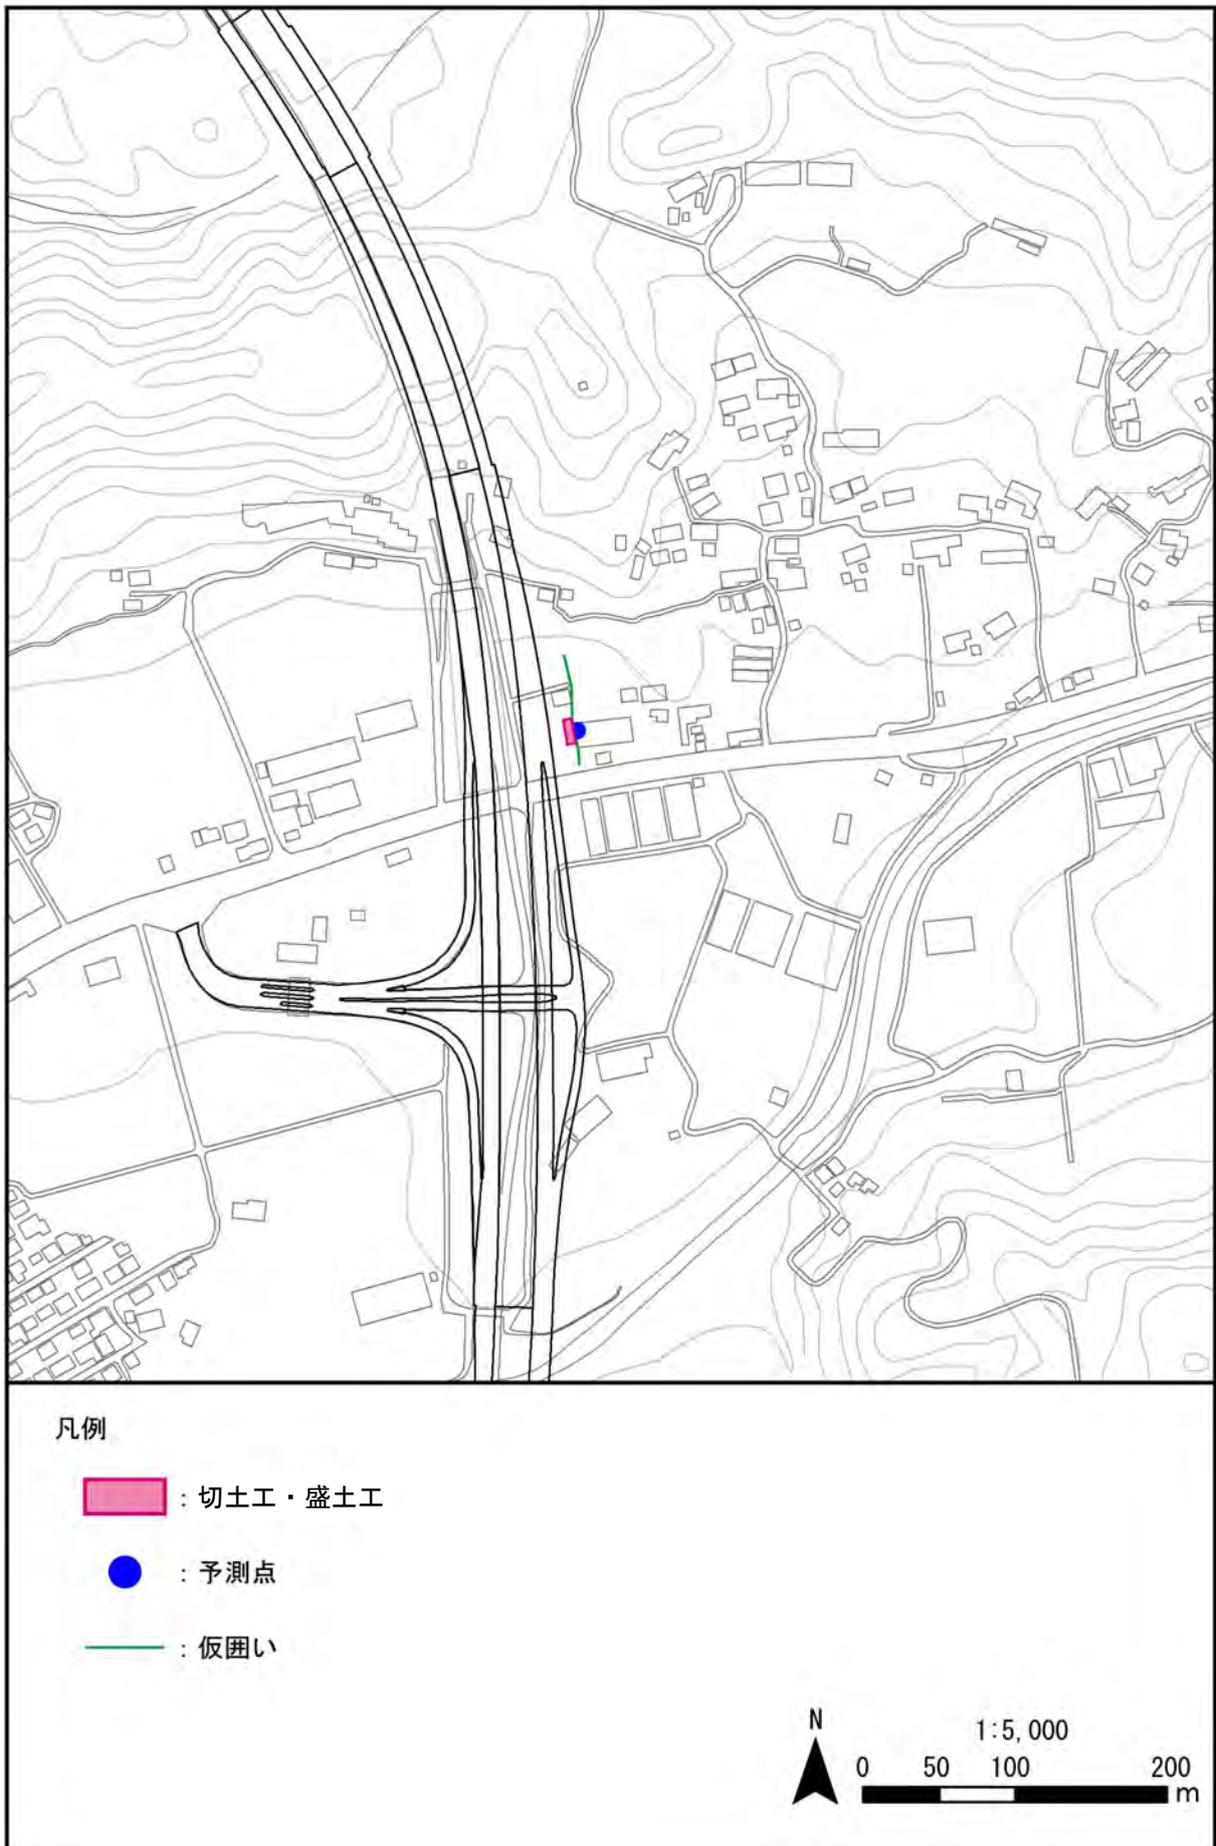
(4) 建設機械の稼働に係る騒音のユニット配置図 (4 鋸南保田 IC 付近)
